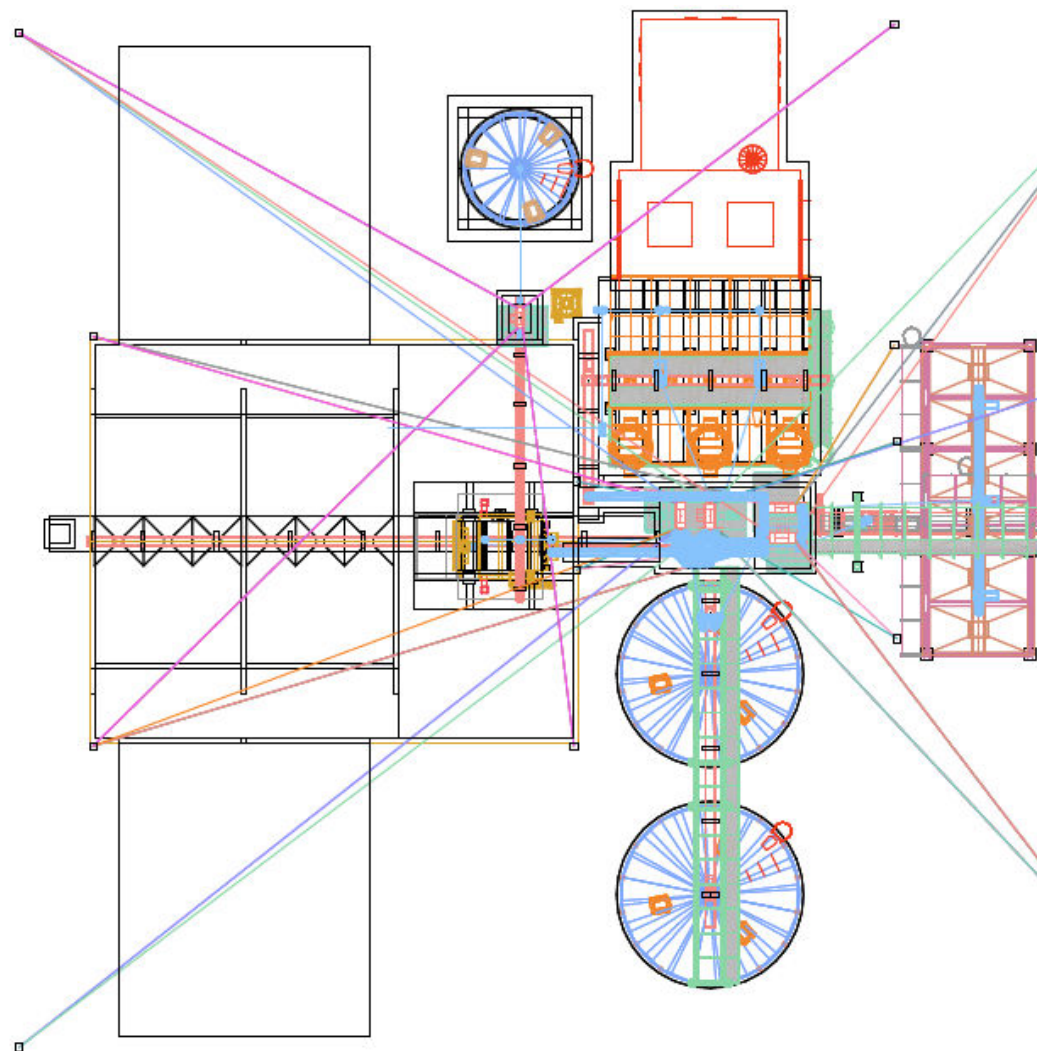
Detalhamento dos equipamentos da área de recebimento e carregamento do silo – silos pulmão, moegas e elevadores de carga.
